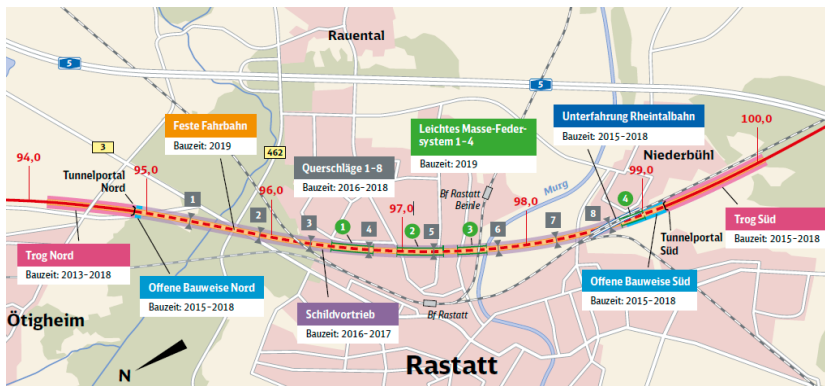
Rohbau Tunnel Rastatt - Bauzeitplan ⁴⁷
